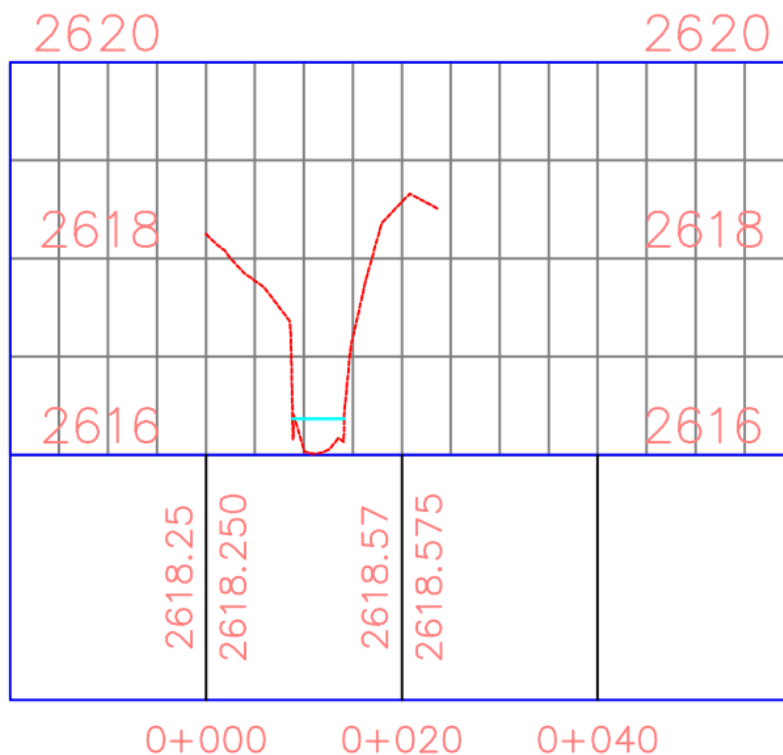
Perfil punto 2 transecto 1 con AUTOCAD-CIVIL 3D, elaboración propia.
